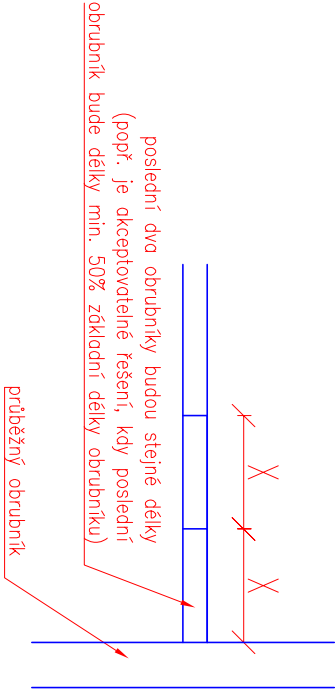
DETAIL ULOŽENÍ OBRUBNÍKŮ M 1:25
